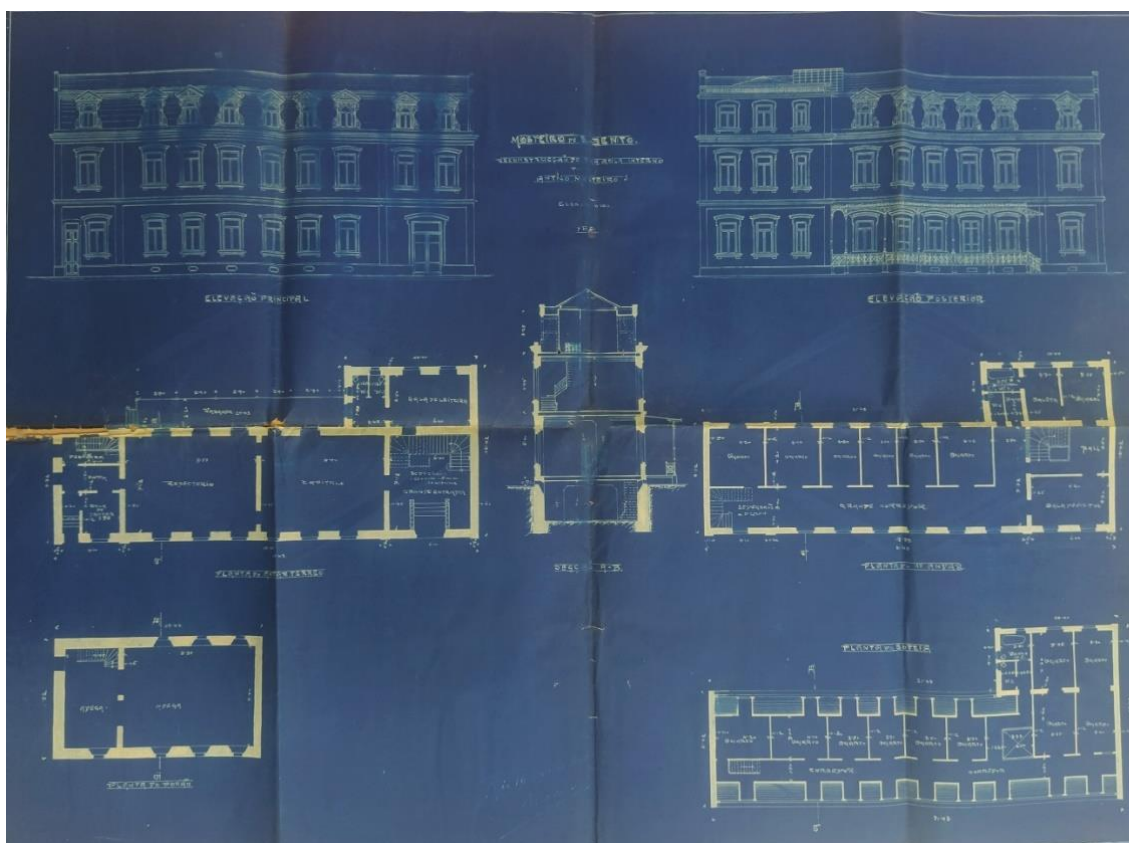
Planta, corte e fachada do Antigo Mosteiro
